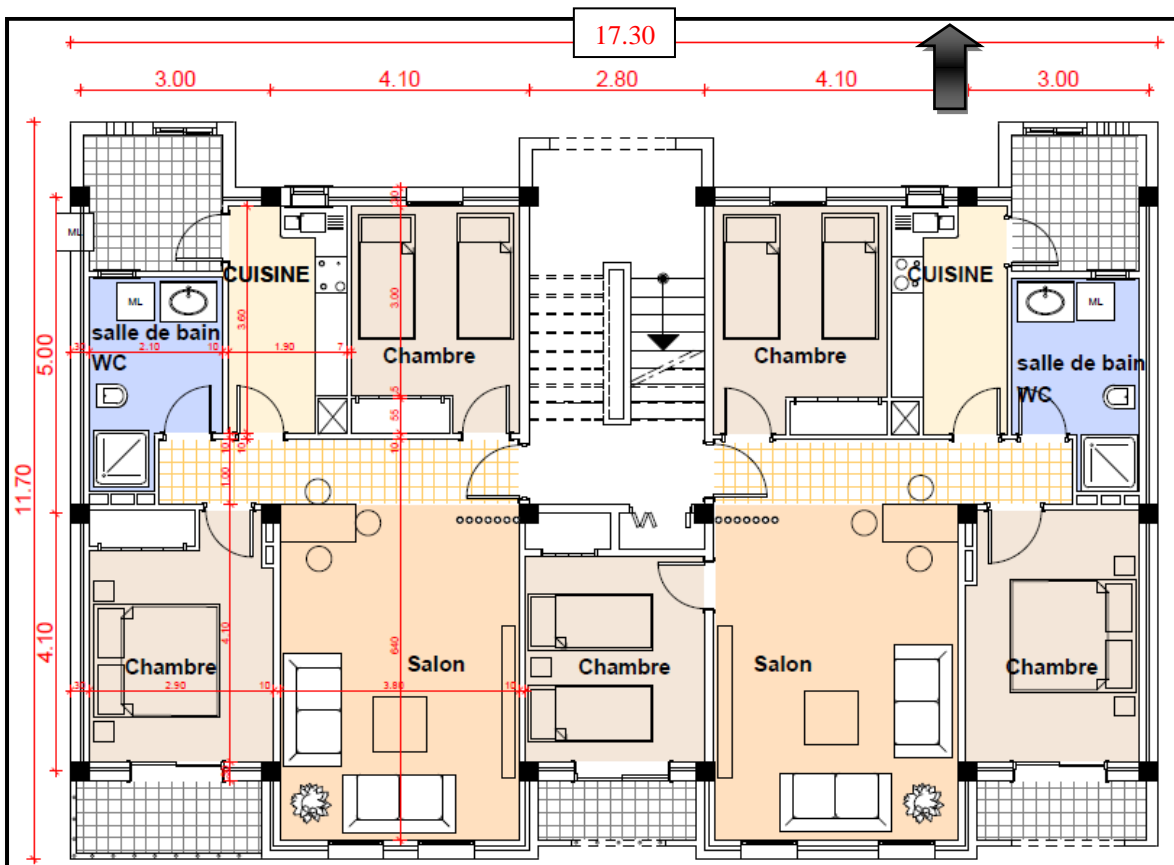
Plan d'étage après la requalification, ECH 1/100
